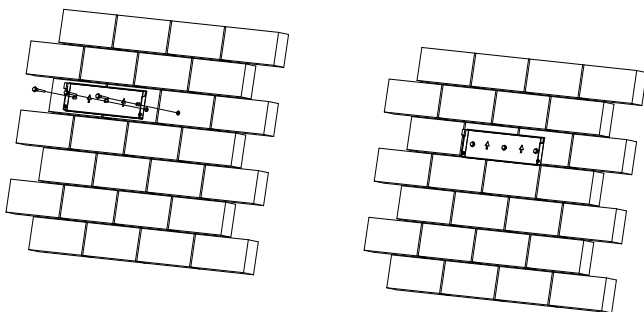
Posizionamento piastra di fissaggio per SUNWAY™ SI-0.7K-3K-S1 & SUNWAY™ SI-3K-8K-S2
